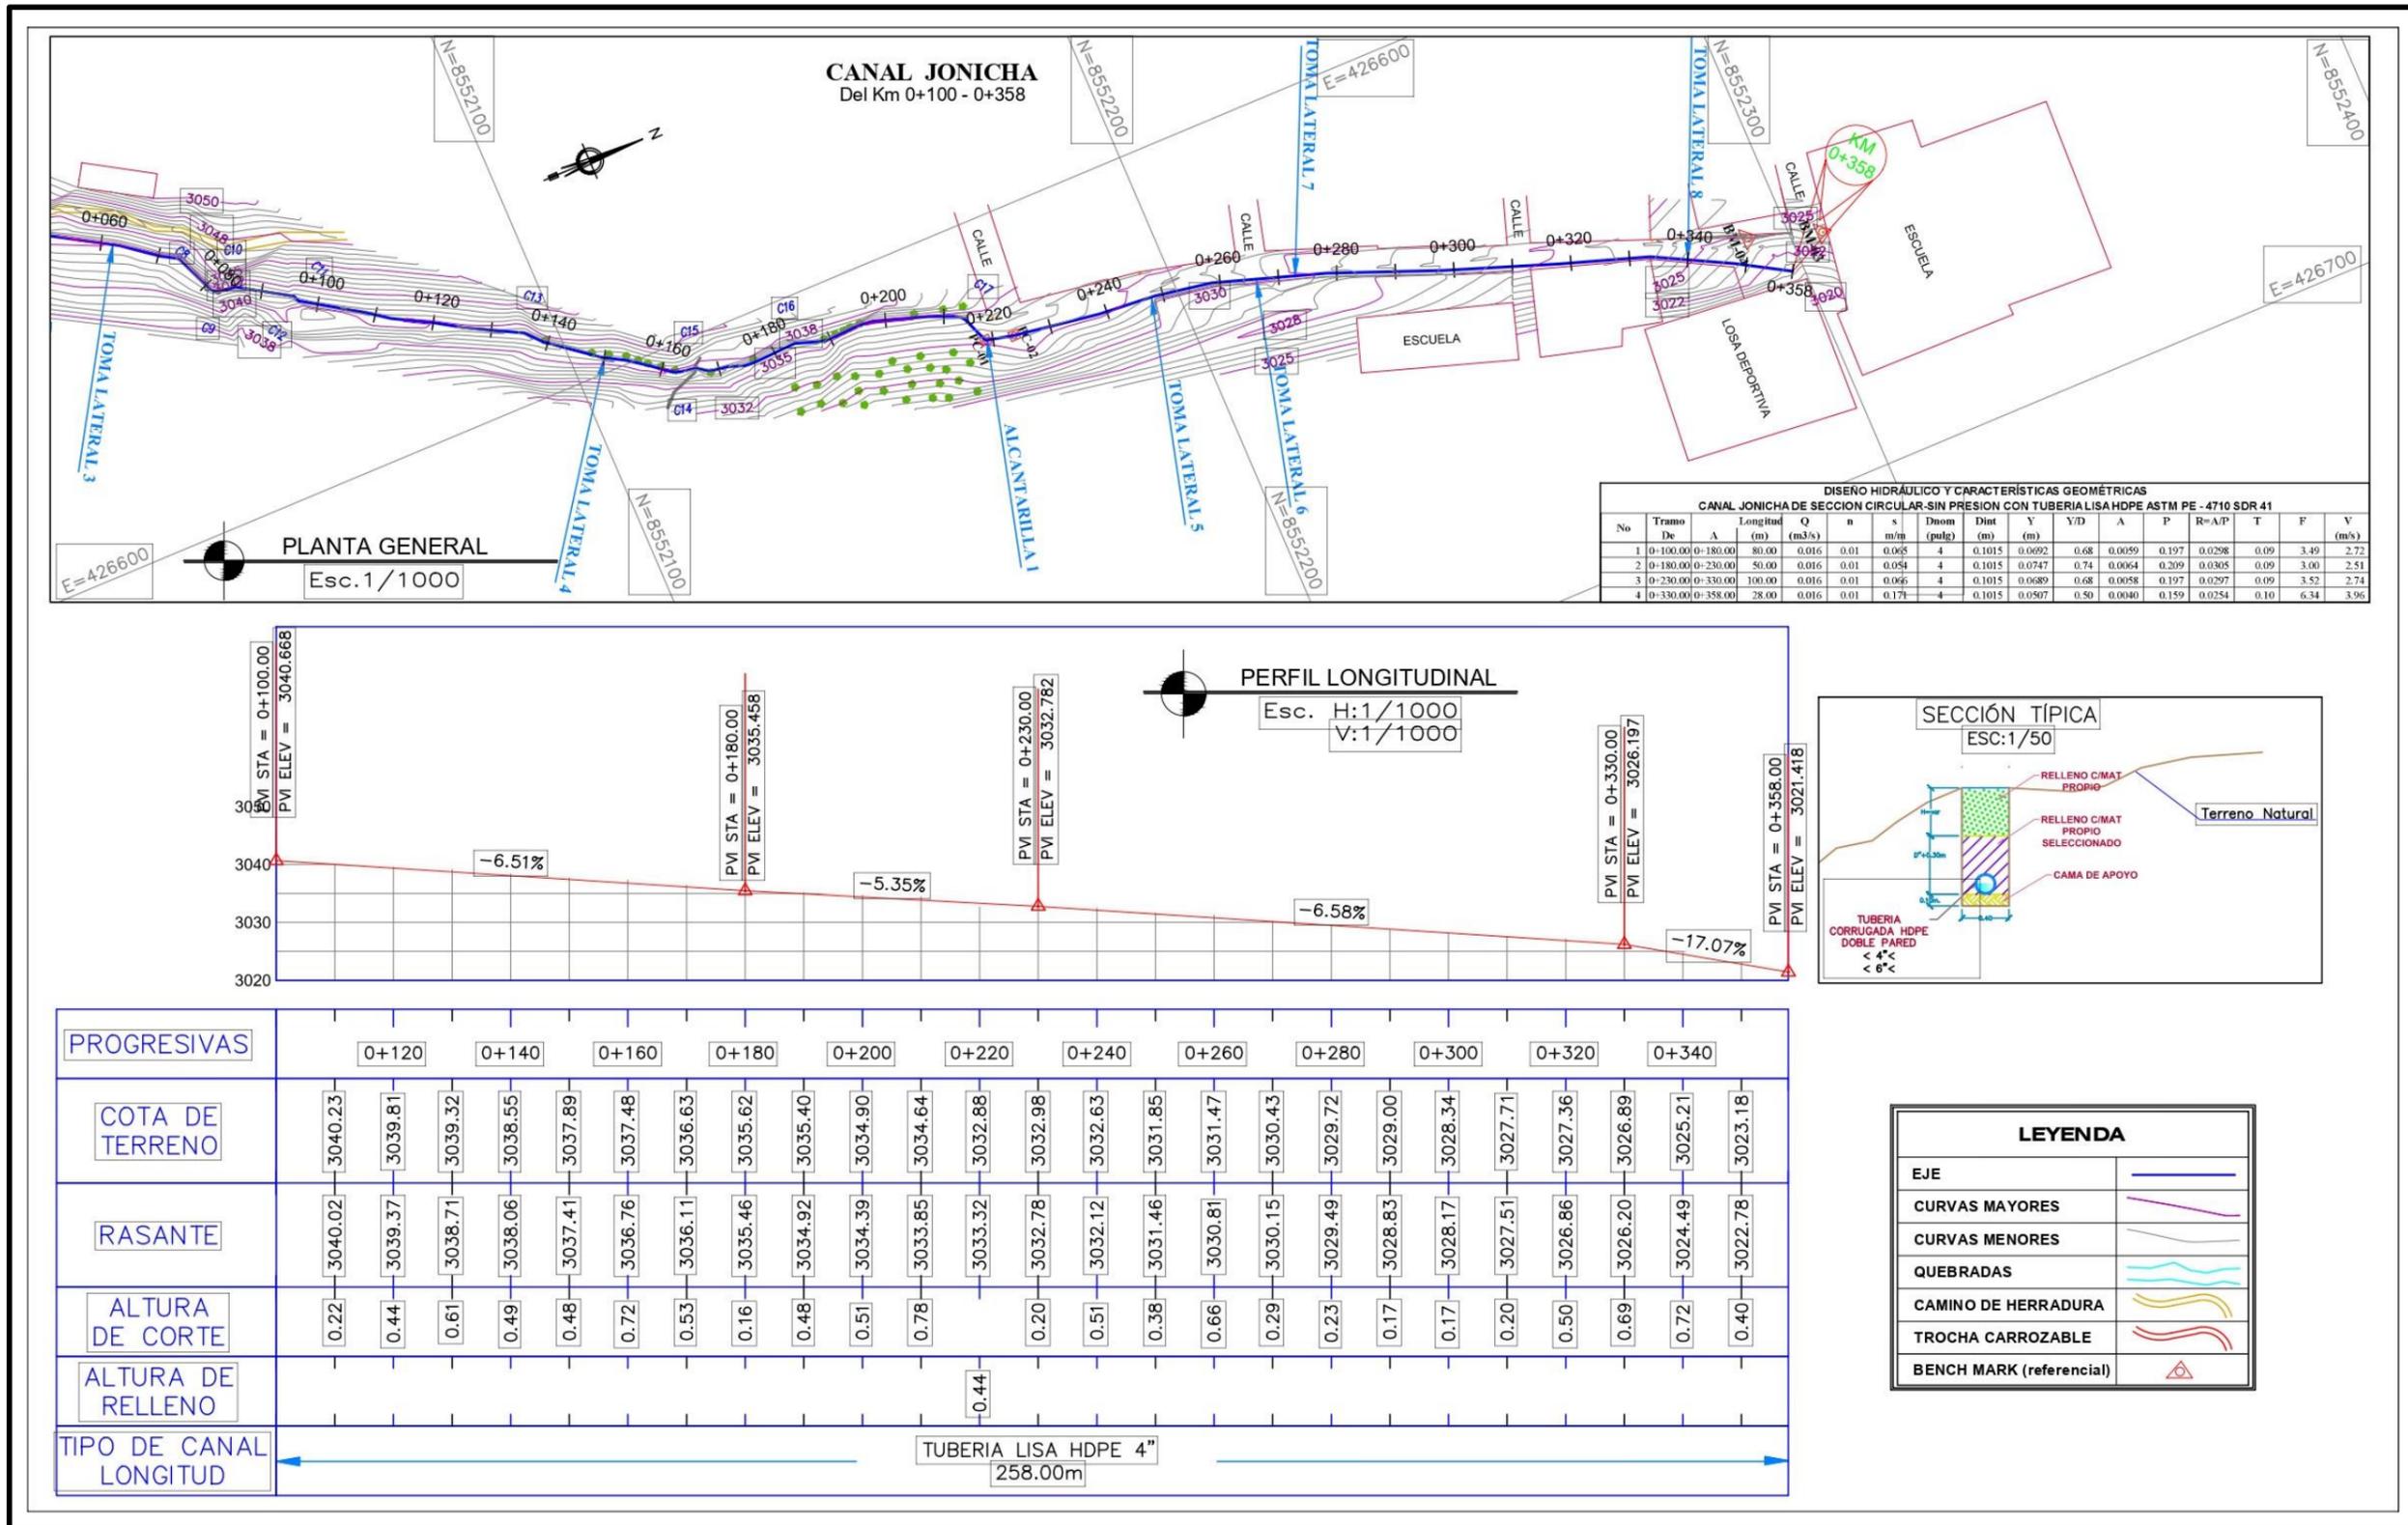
Plano de planta y perfil longitudinal del canal Jonicha
